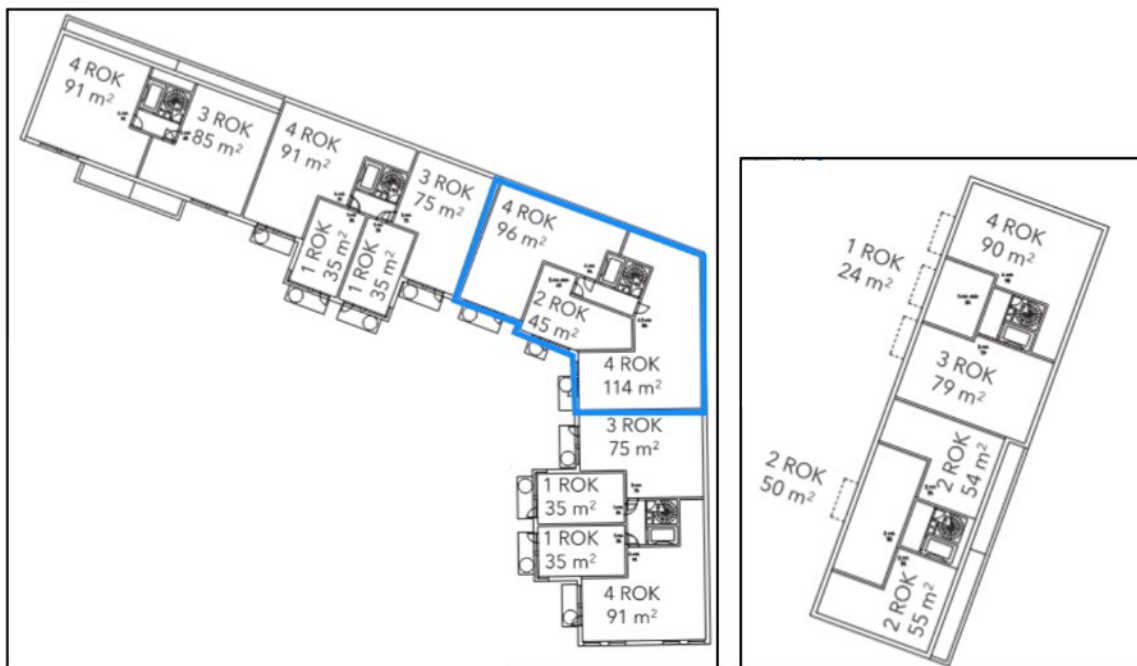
Möjligt typplan Hus 3 för plan 8 till 12 och toppvåning (Structor, 2025).
